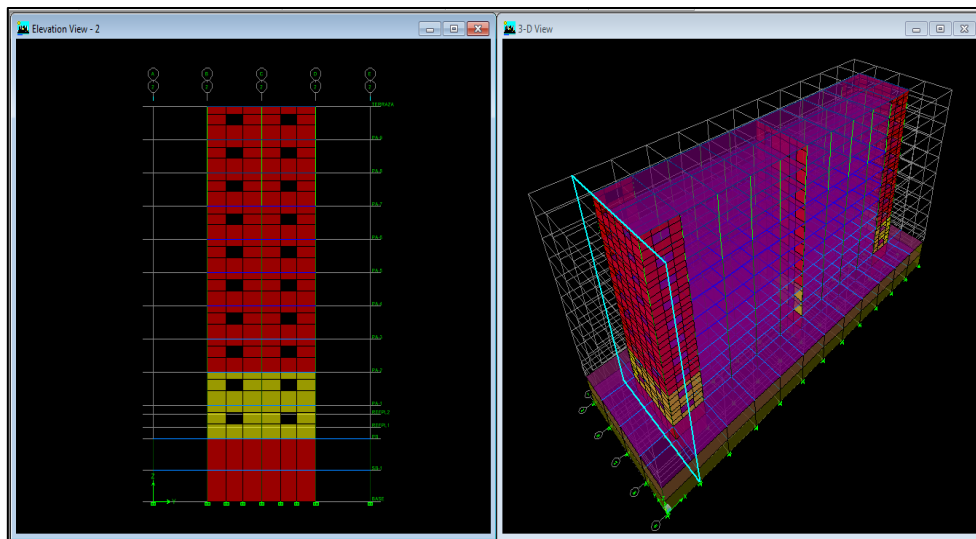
(a) Vista en elevación del muro a diseñarse.
